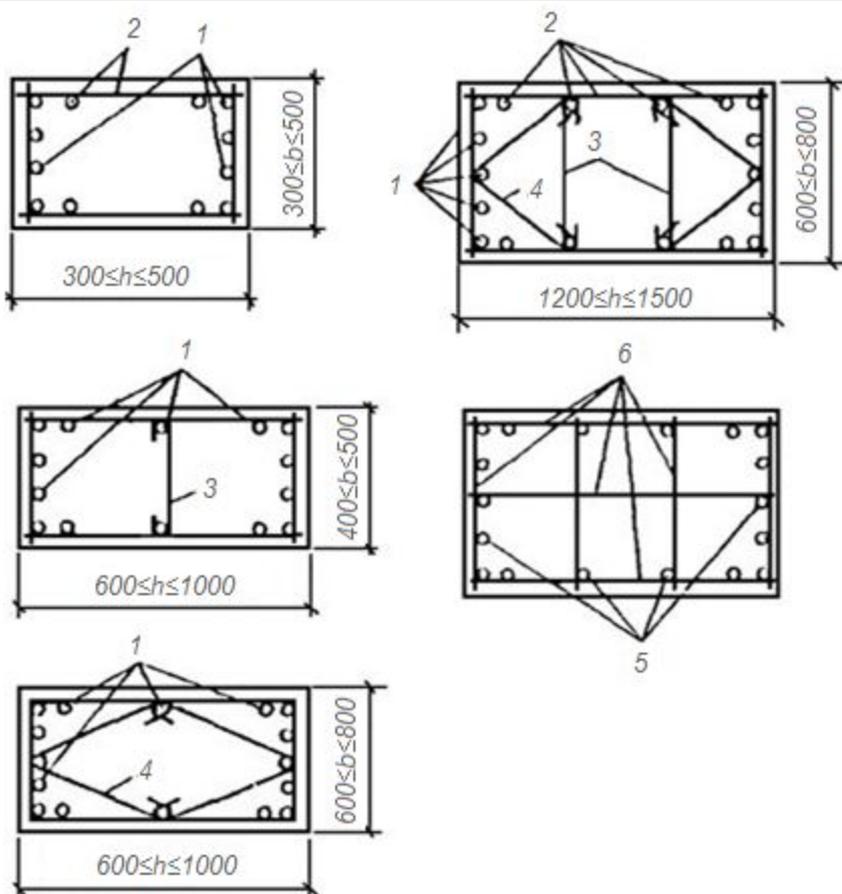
Примеры армирования сечений колонн с рекомендуемым числом стержней сварными сетками:
